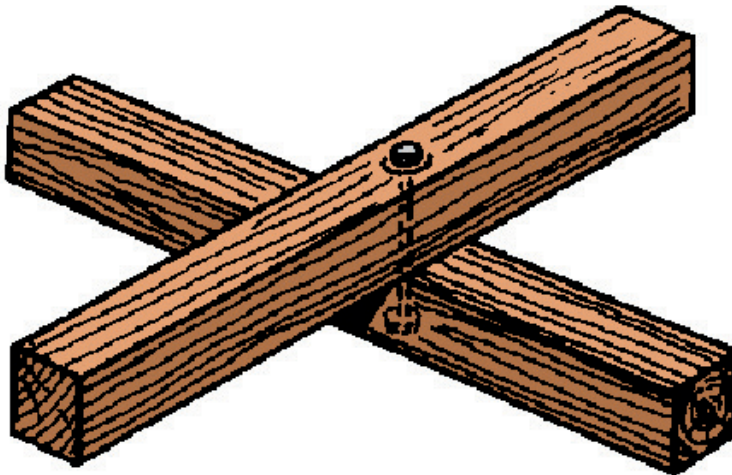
gekreuzte Kanthölzer durch Gewindestange gesichert
